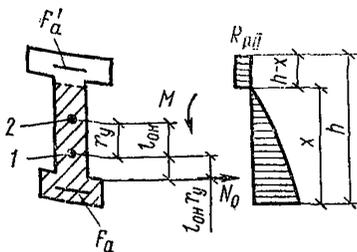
Схема усилий и эпюра напряжений в поперечном сечении элемента при расчете его по образованию трещин, нормальных к продольной оси элемента, в зоне сечения, растянутой от действия усилий предварительного обжатия
